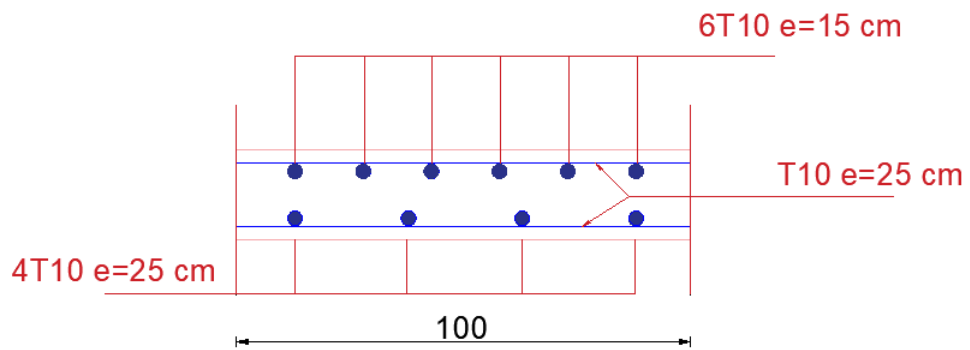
Ferrailage du Voile Périphérique(x-x).
